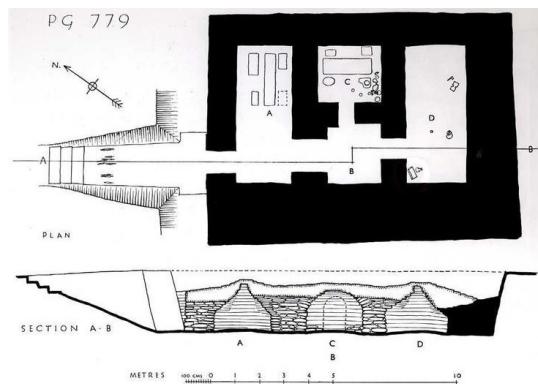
Cobertura em cúpula circular sobre planta quadrada com recurso a trompas em consola (câmaras B e C). Túmulo privado (PG) 779: planta e corte, cemitério real de Ur (c. 2500 a.C.).
